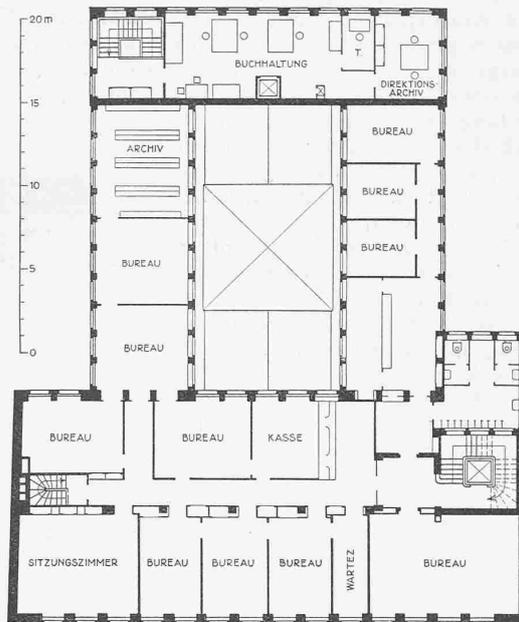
Grundriss vom Obergeschoss. — Masstab 1 : 400.
